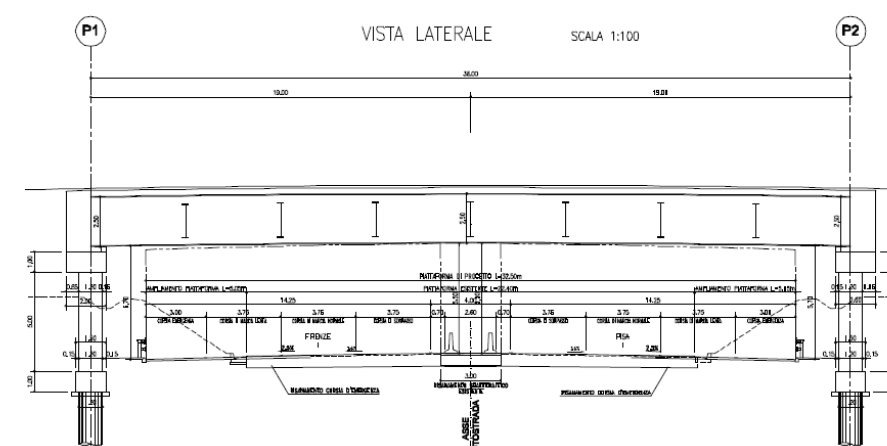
Sezione longitudinale cavalcavia ad una luce
